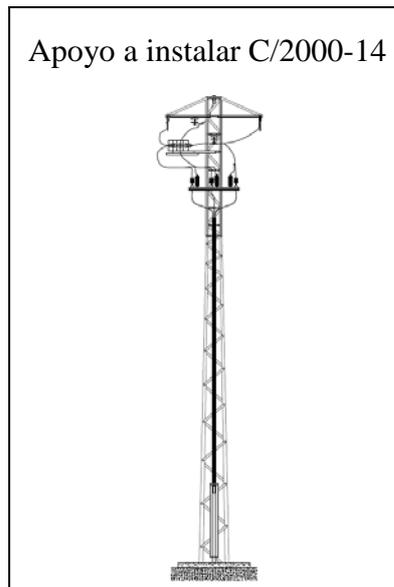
Poste de madera 1 a cambiar por apoyo metálico C2000-14
